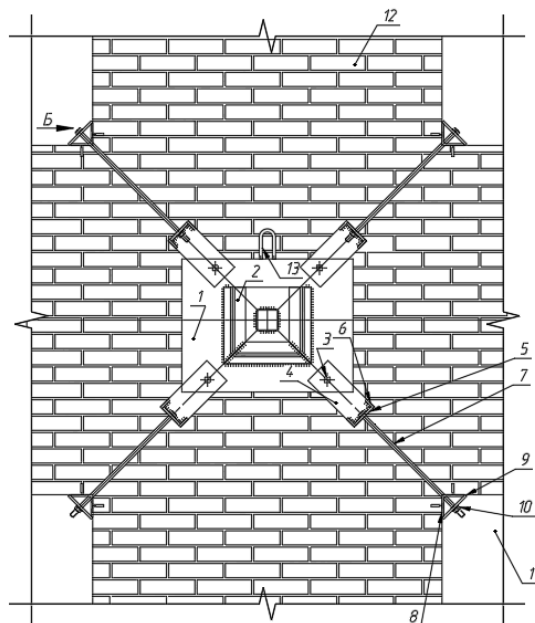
Конструкция для временного усиления кирпичных стен с проемами при демонтированных перекрытиях (изображен разрез I-I на рис. 2):
